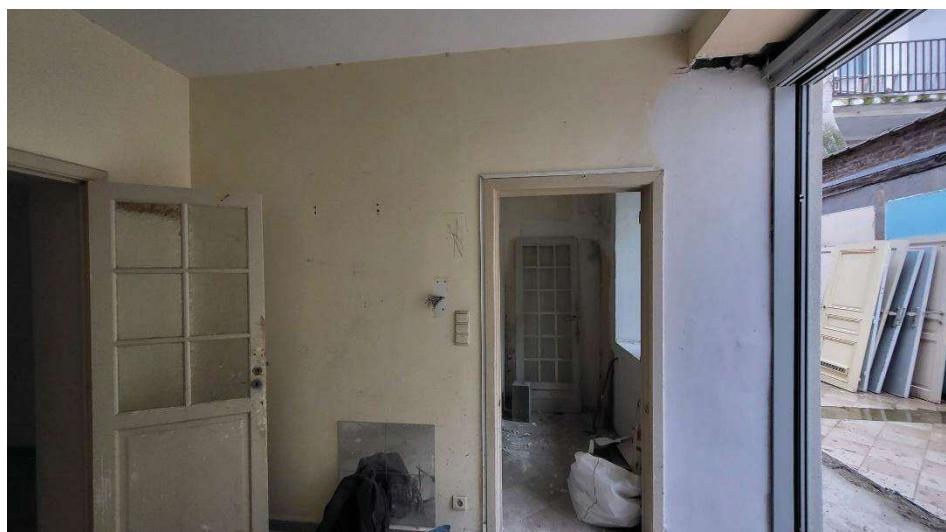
Sondage dans le mur à modifier, à hauteur du niveau sous linteau projeté
